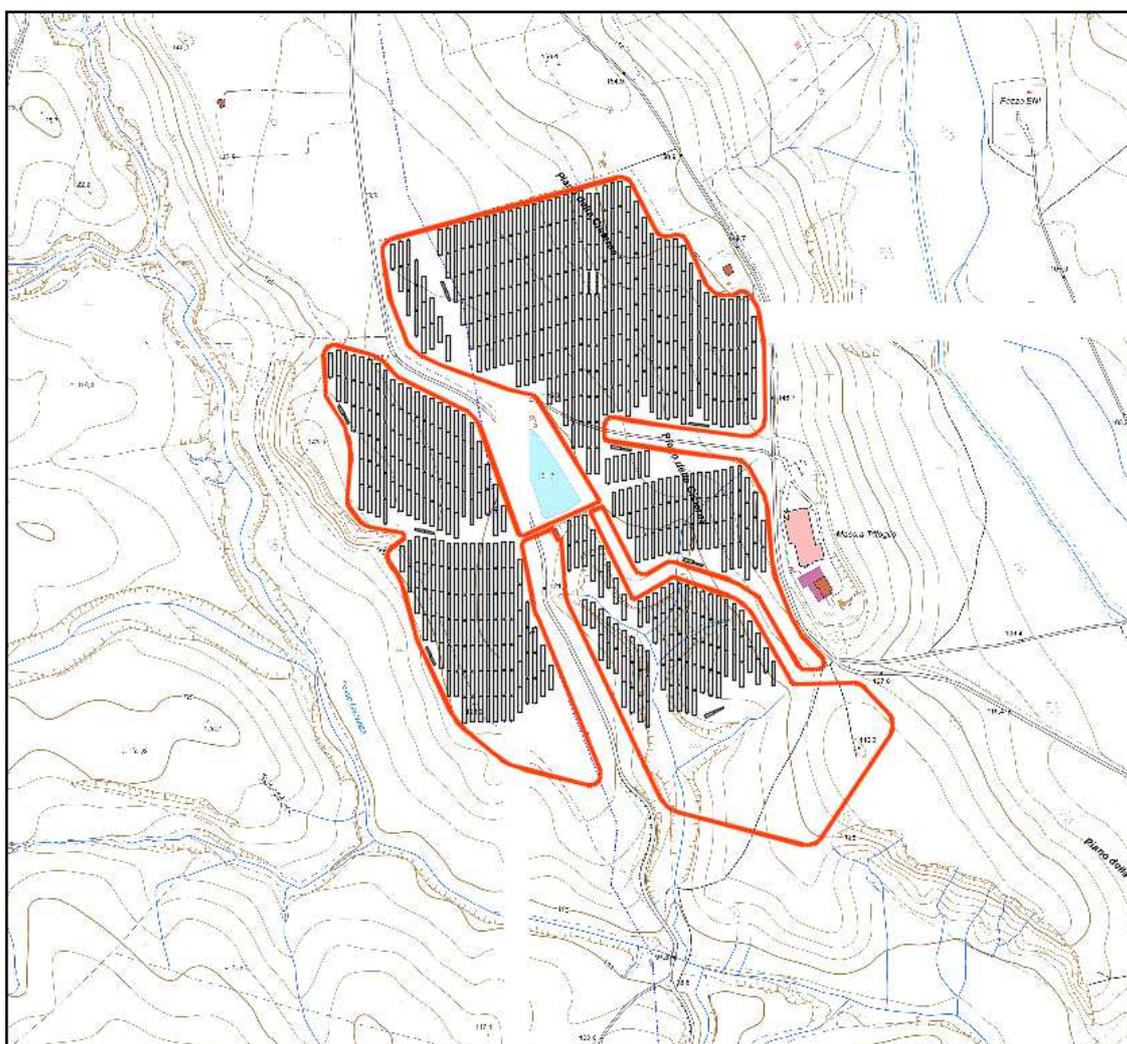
Stralcio della C.T.R. con individuazione dell'impianto
